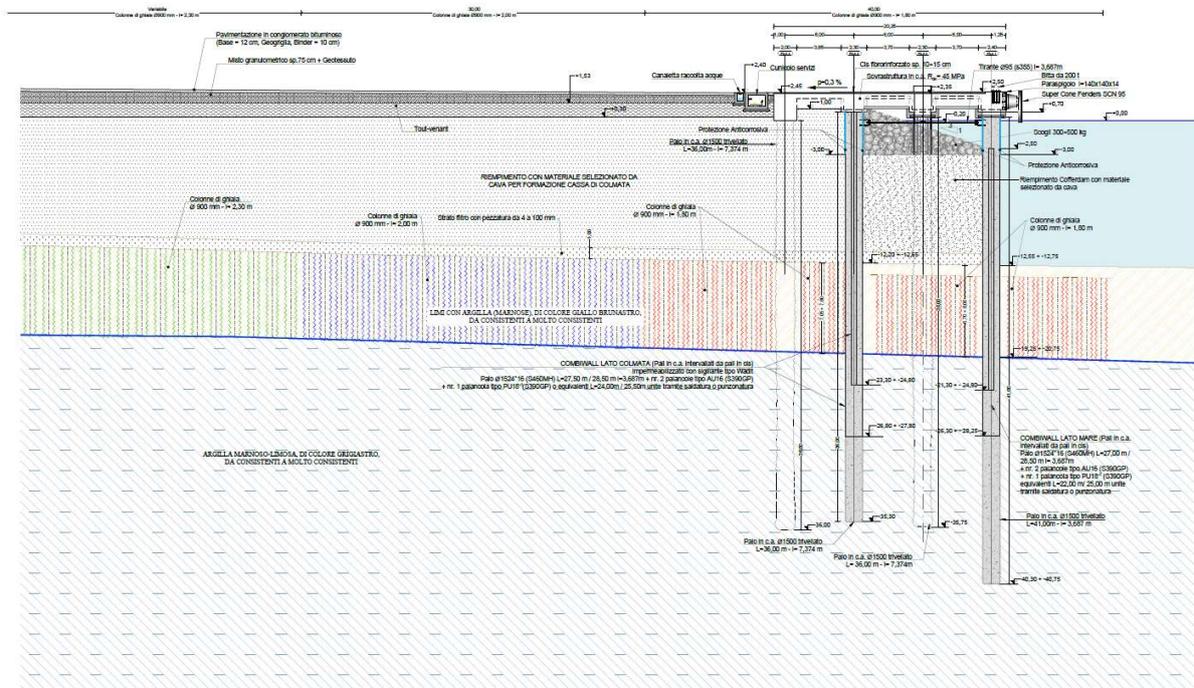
Banchina di Testata – Sezione “Tipo 5”
